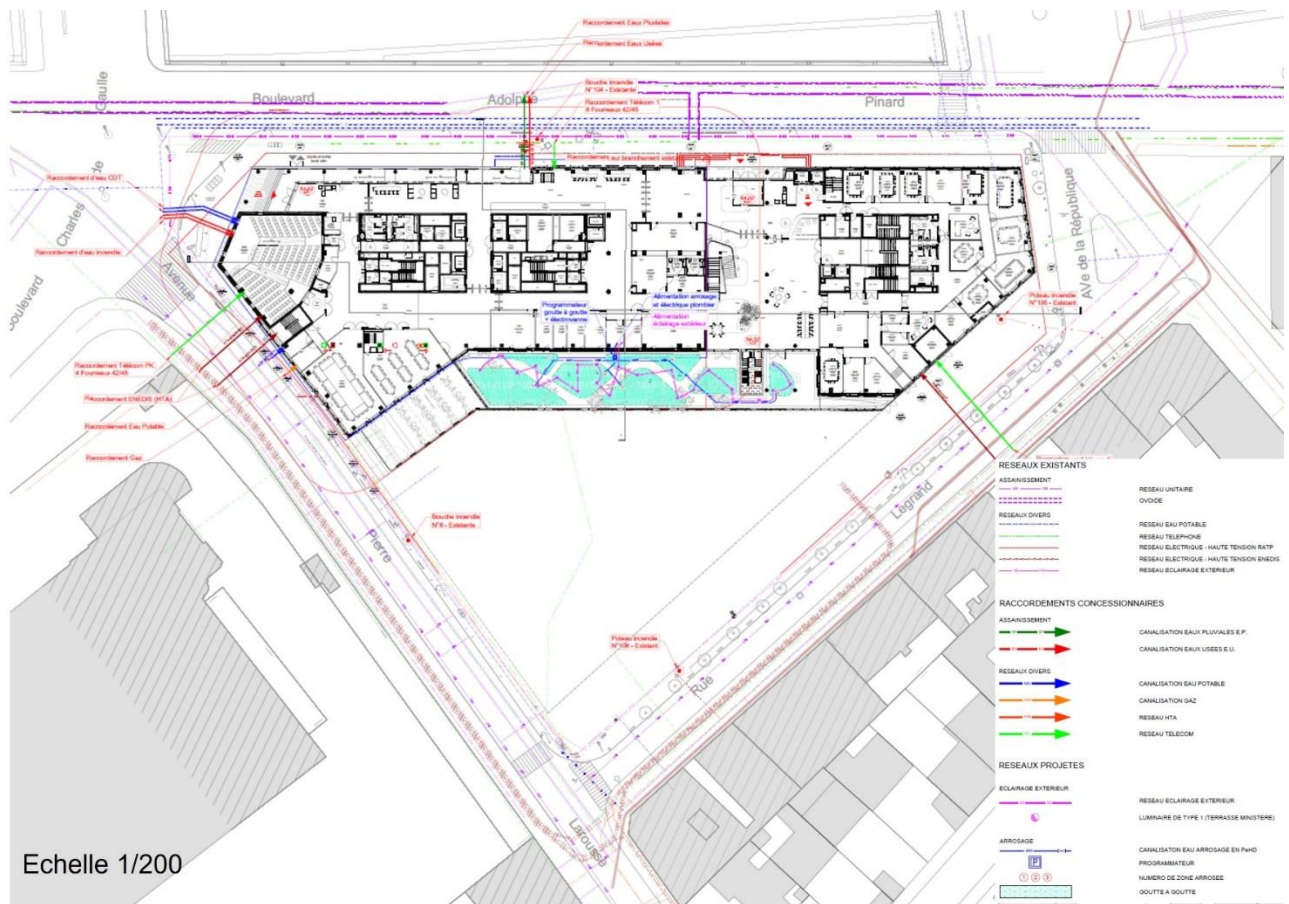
Plan de principe d'assainissement et des réseaux divers (Source : groupement, Cabinet Viguié, 28/02/2023)
